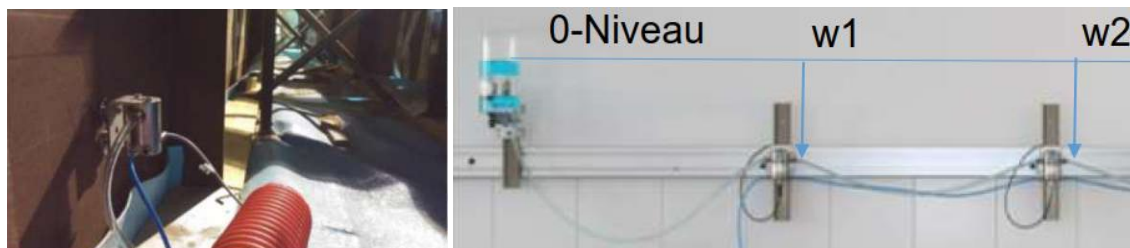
Elektronische Schlauchwaage (links) mit Prinzipskizze (rechts) [21]
